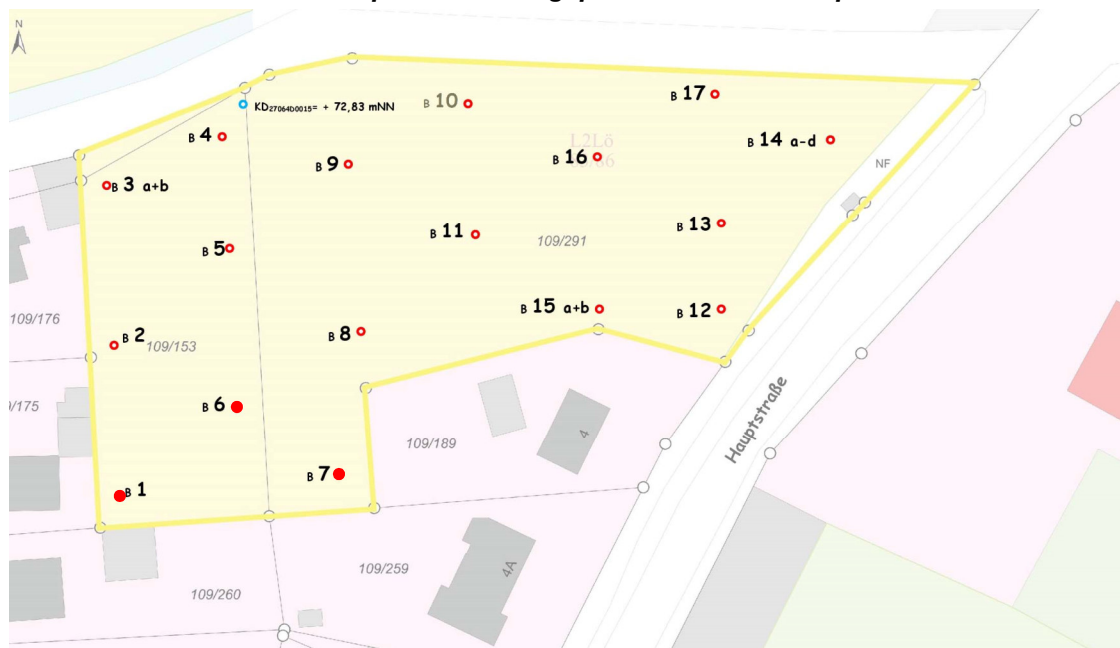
Bohrprofile und Lageplan der Bohransatzpunkte
